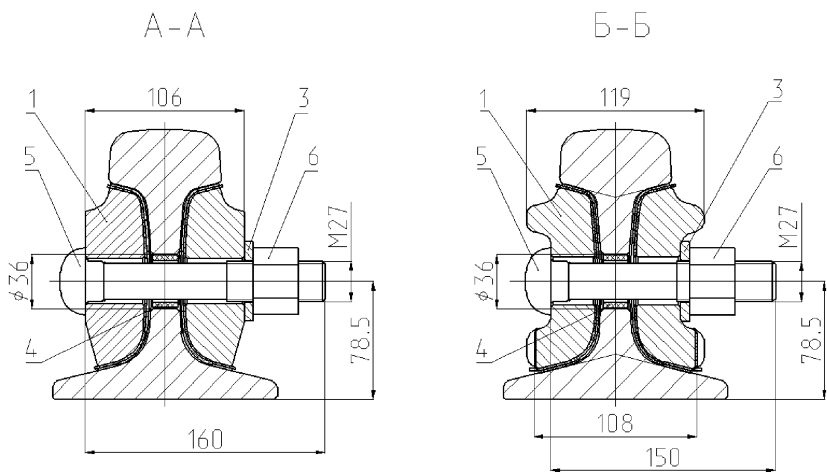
Стык, изолирующий рельсов типа Р65 с комбинированными (металлокомпозитными) накладками
